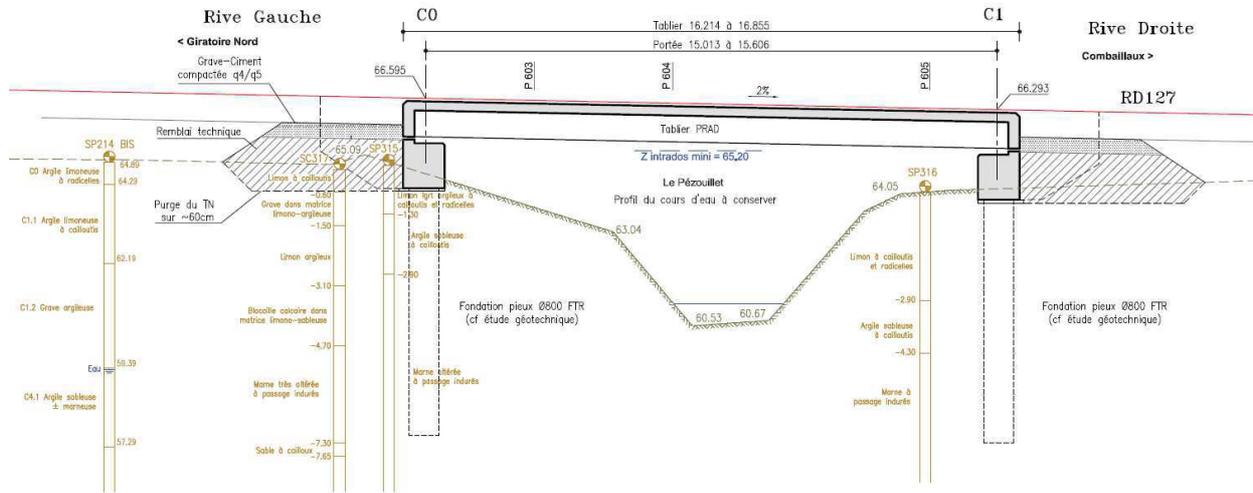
plan de coupe de l'ouvrage de franchissement du Pézouillet (ou Lichauda)
